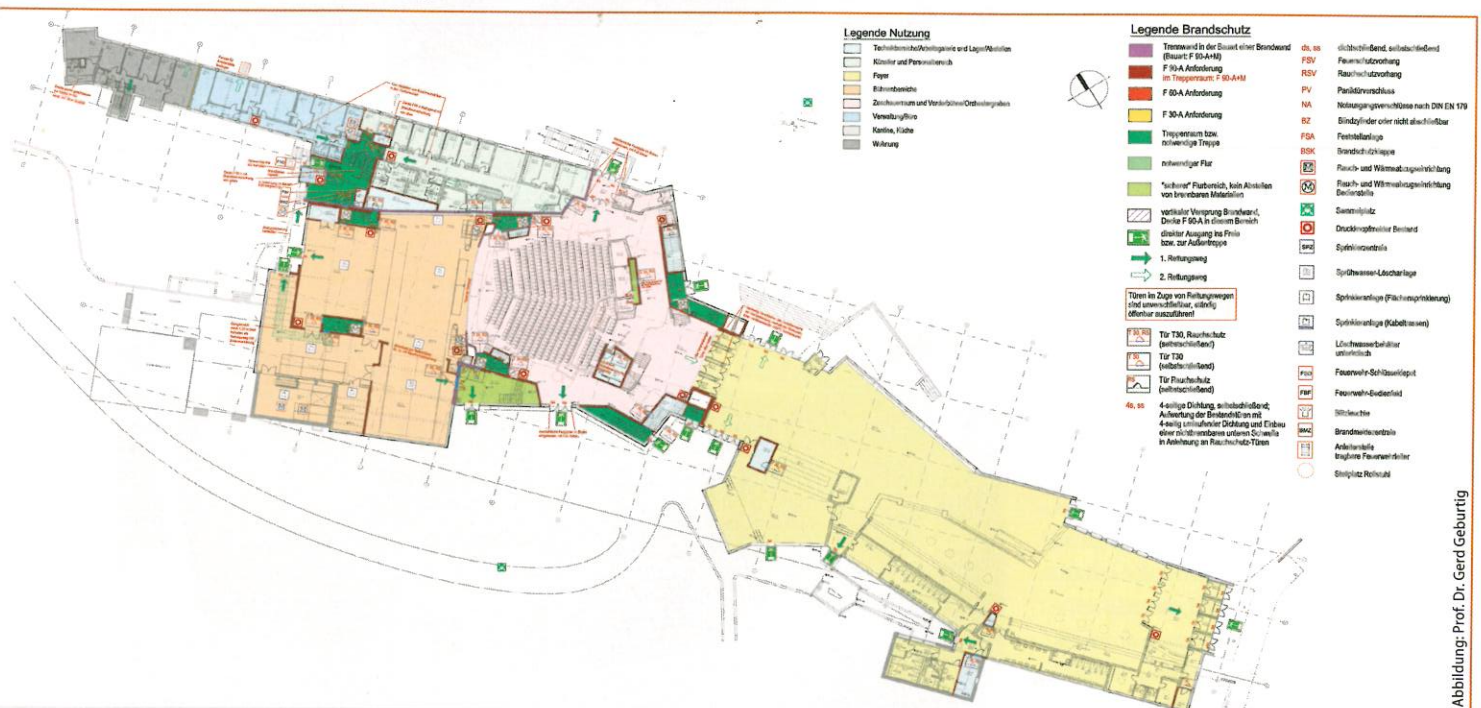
Grundriss aus dem Brandschutzkonzept
